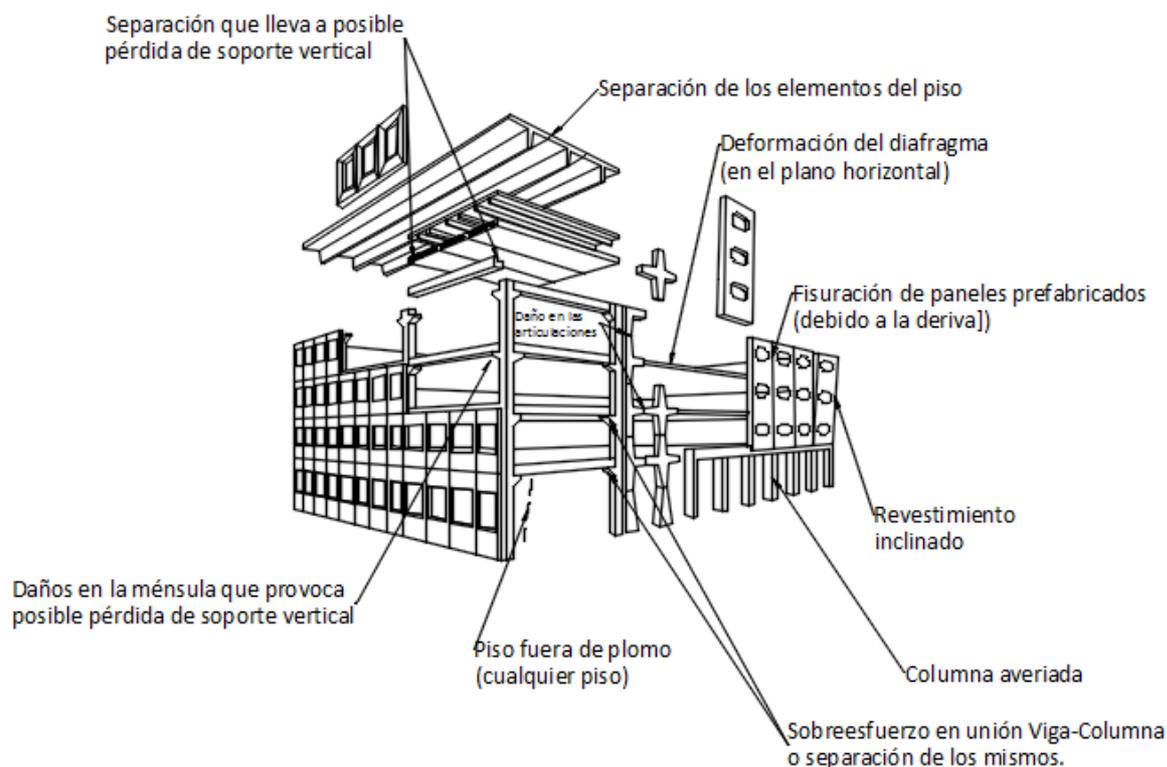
Puntos de inspección para edificaciones de hormigón prefabricado
